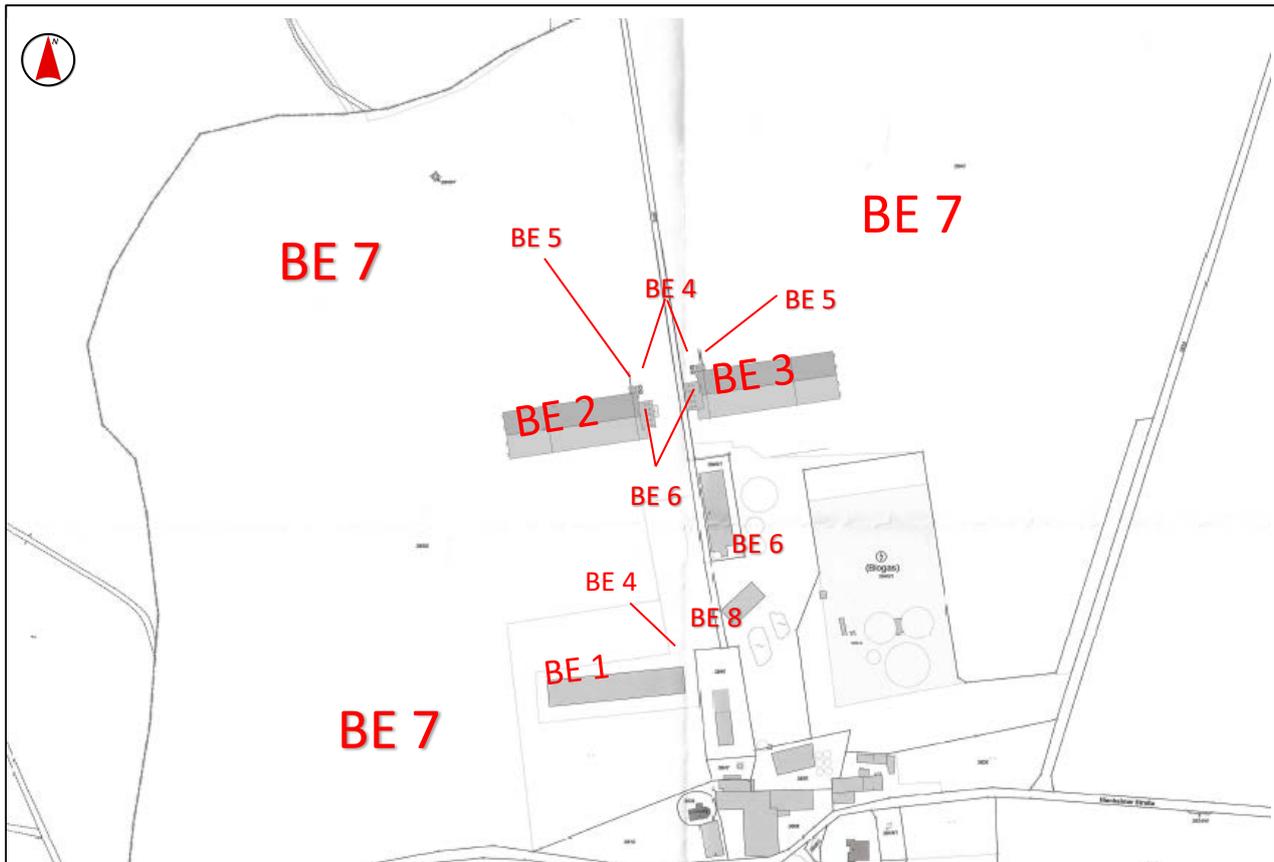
Lageplan der Tierhaltungsanlage mit Betriebseinheiten
